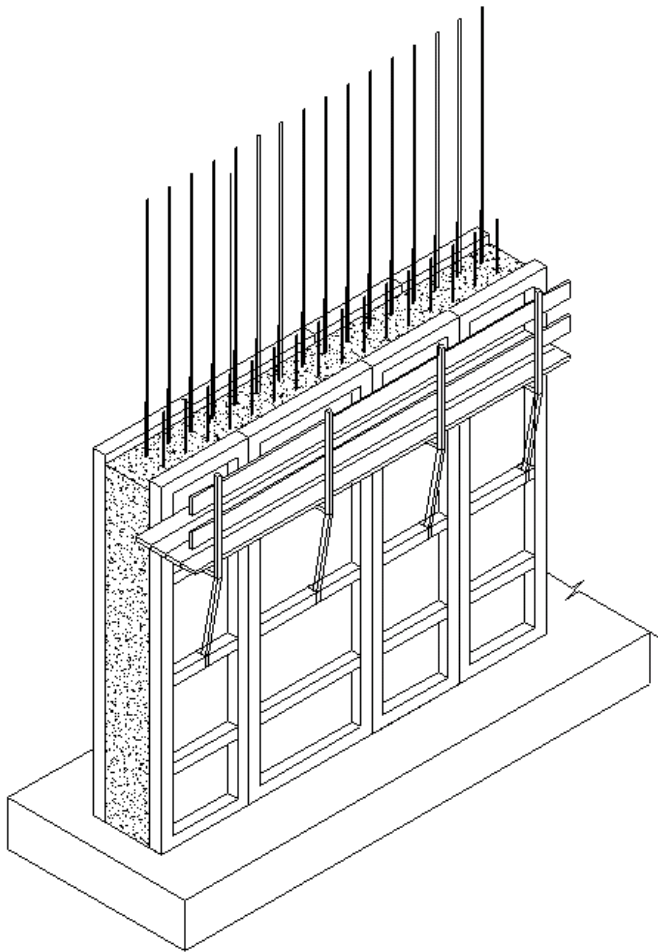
Армирование второго (вышележащего) яруса подпорной стены
